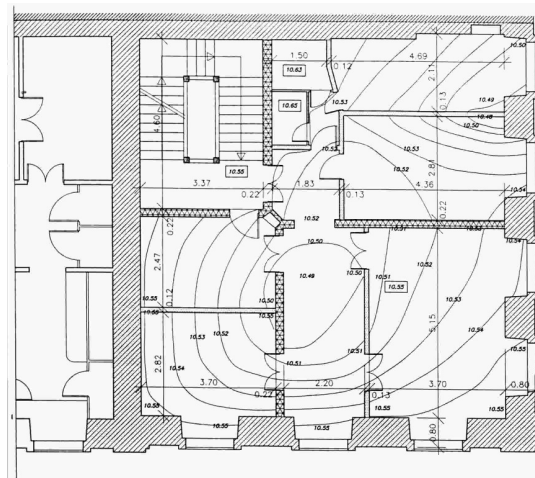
Planta de um piso, evidenciando as deformações do pavimento.
